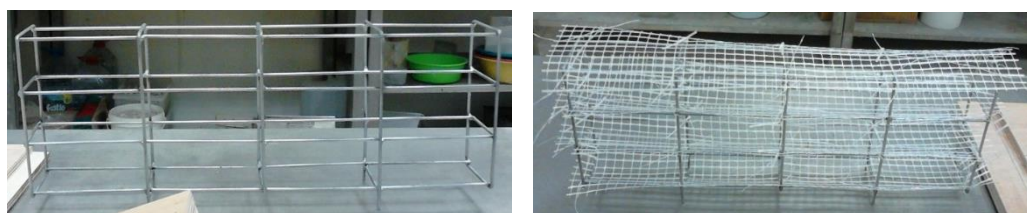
Armadura C1, simples e com rede de fibra de vidro 10 x10 (mm) incorporada
